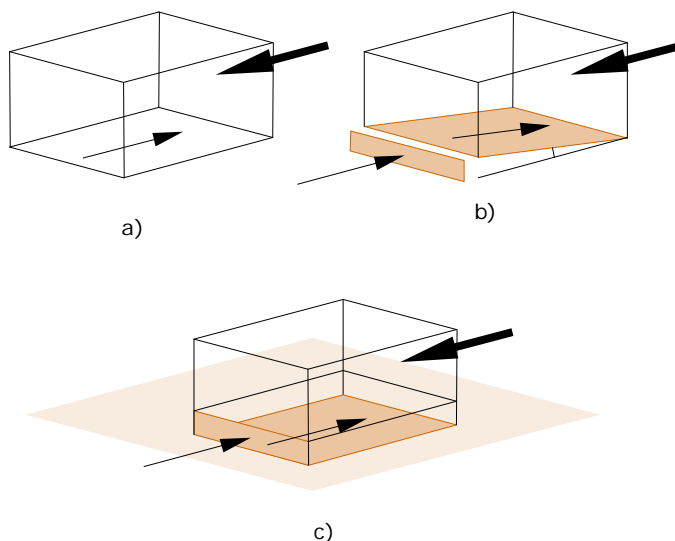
3. Elementos de anclaje de conducciones. a) dado de hormigón simple b) dado inclinado c) dado maclado en el terreno
